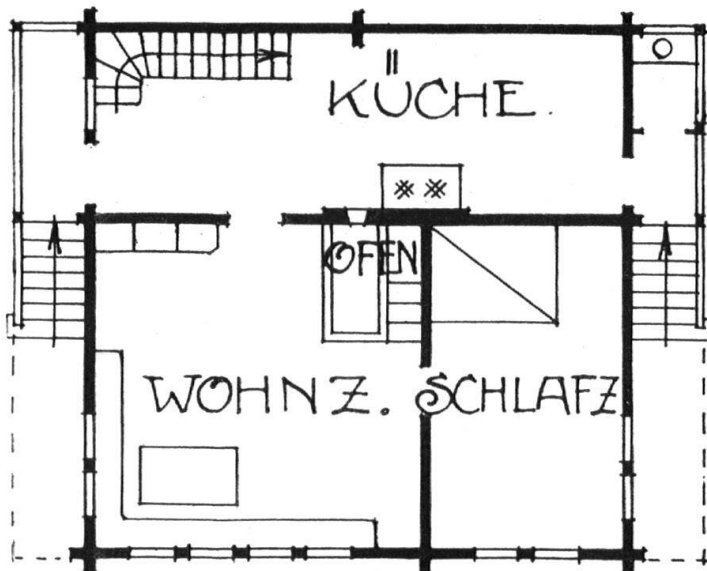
Grundriss. Alter Chalet-Typ. — Fig. 6. Plan d'un ancien type de chalet.
